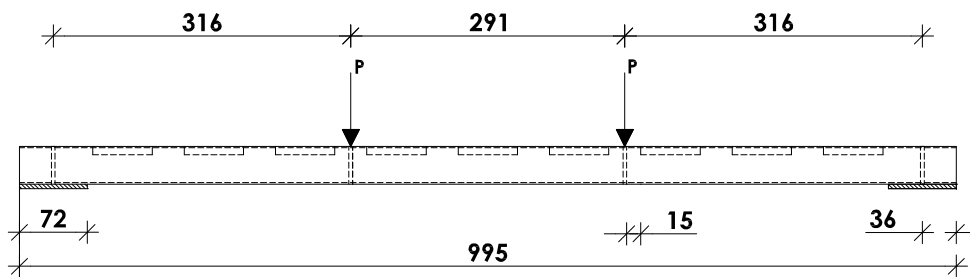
Alçado do ensaio tipo 90×1.5\_Fz1\_Liso (dimensões em mm).
